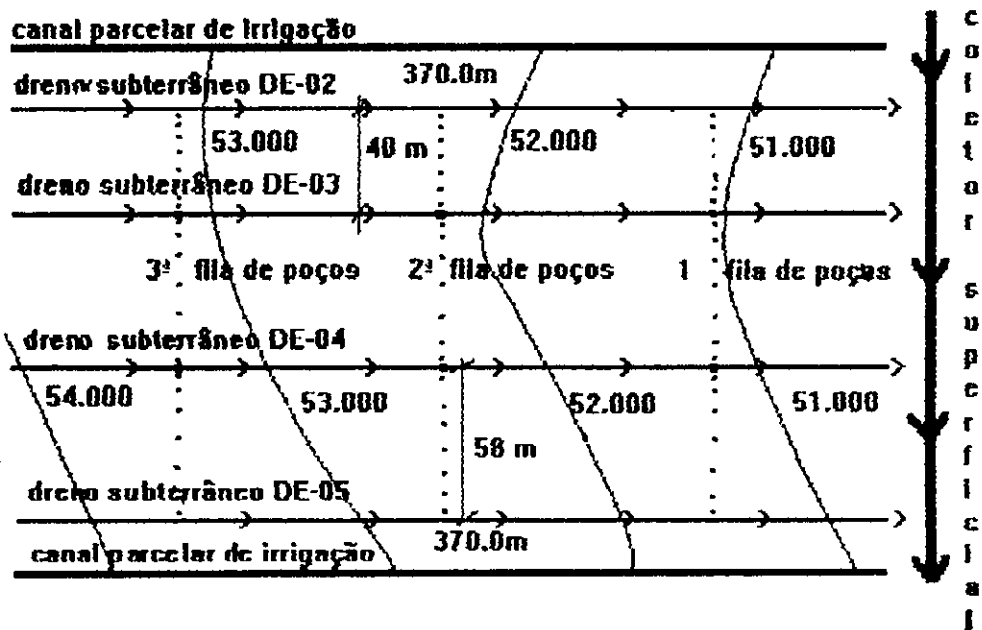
Planta altimétrica do lote 019 ensaio 02
